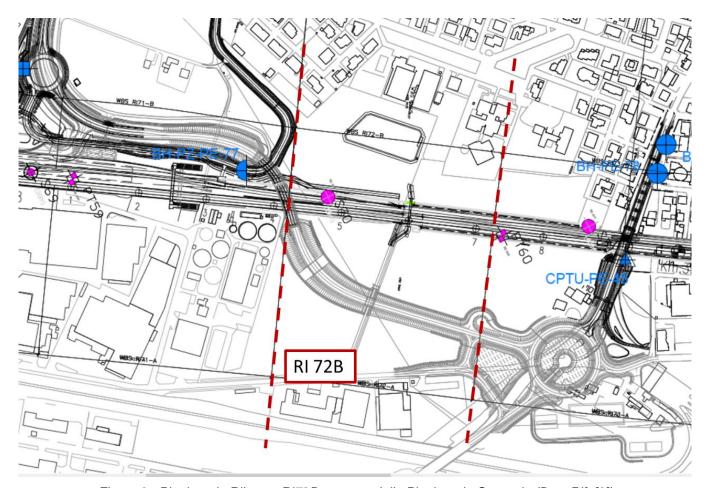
Planimetria Rilevato RI72B, estratto dalla Planimetria Generale (Doc. Rif. [3])
